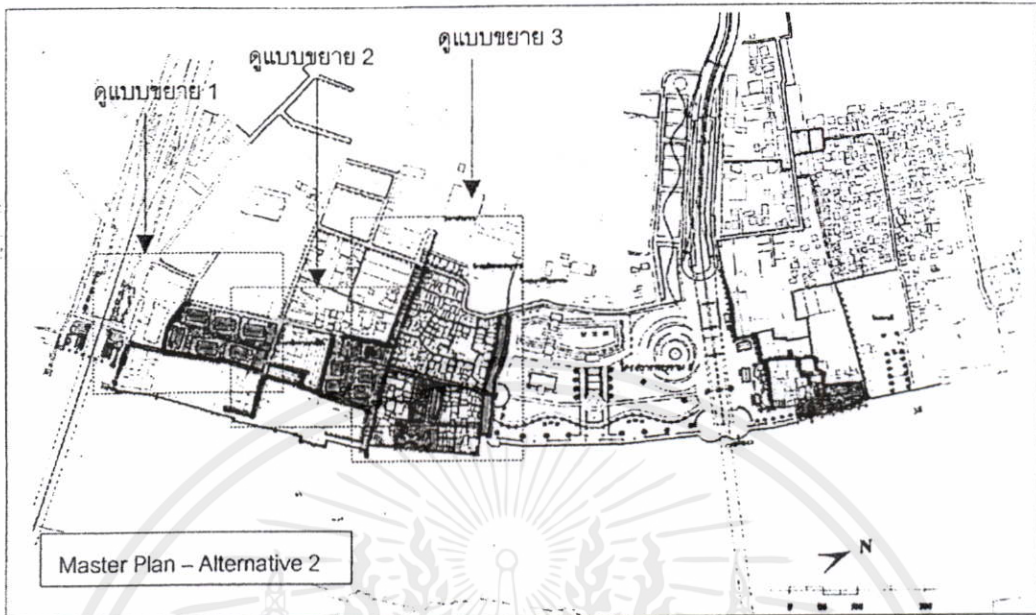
แสดง Existion Plan & Master Plan
